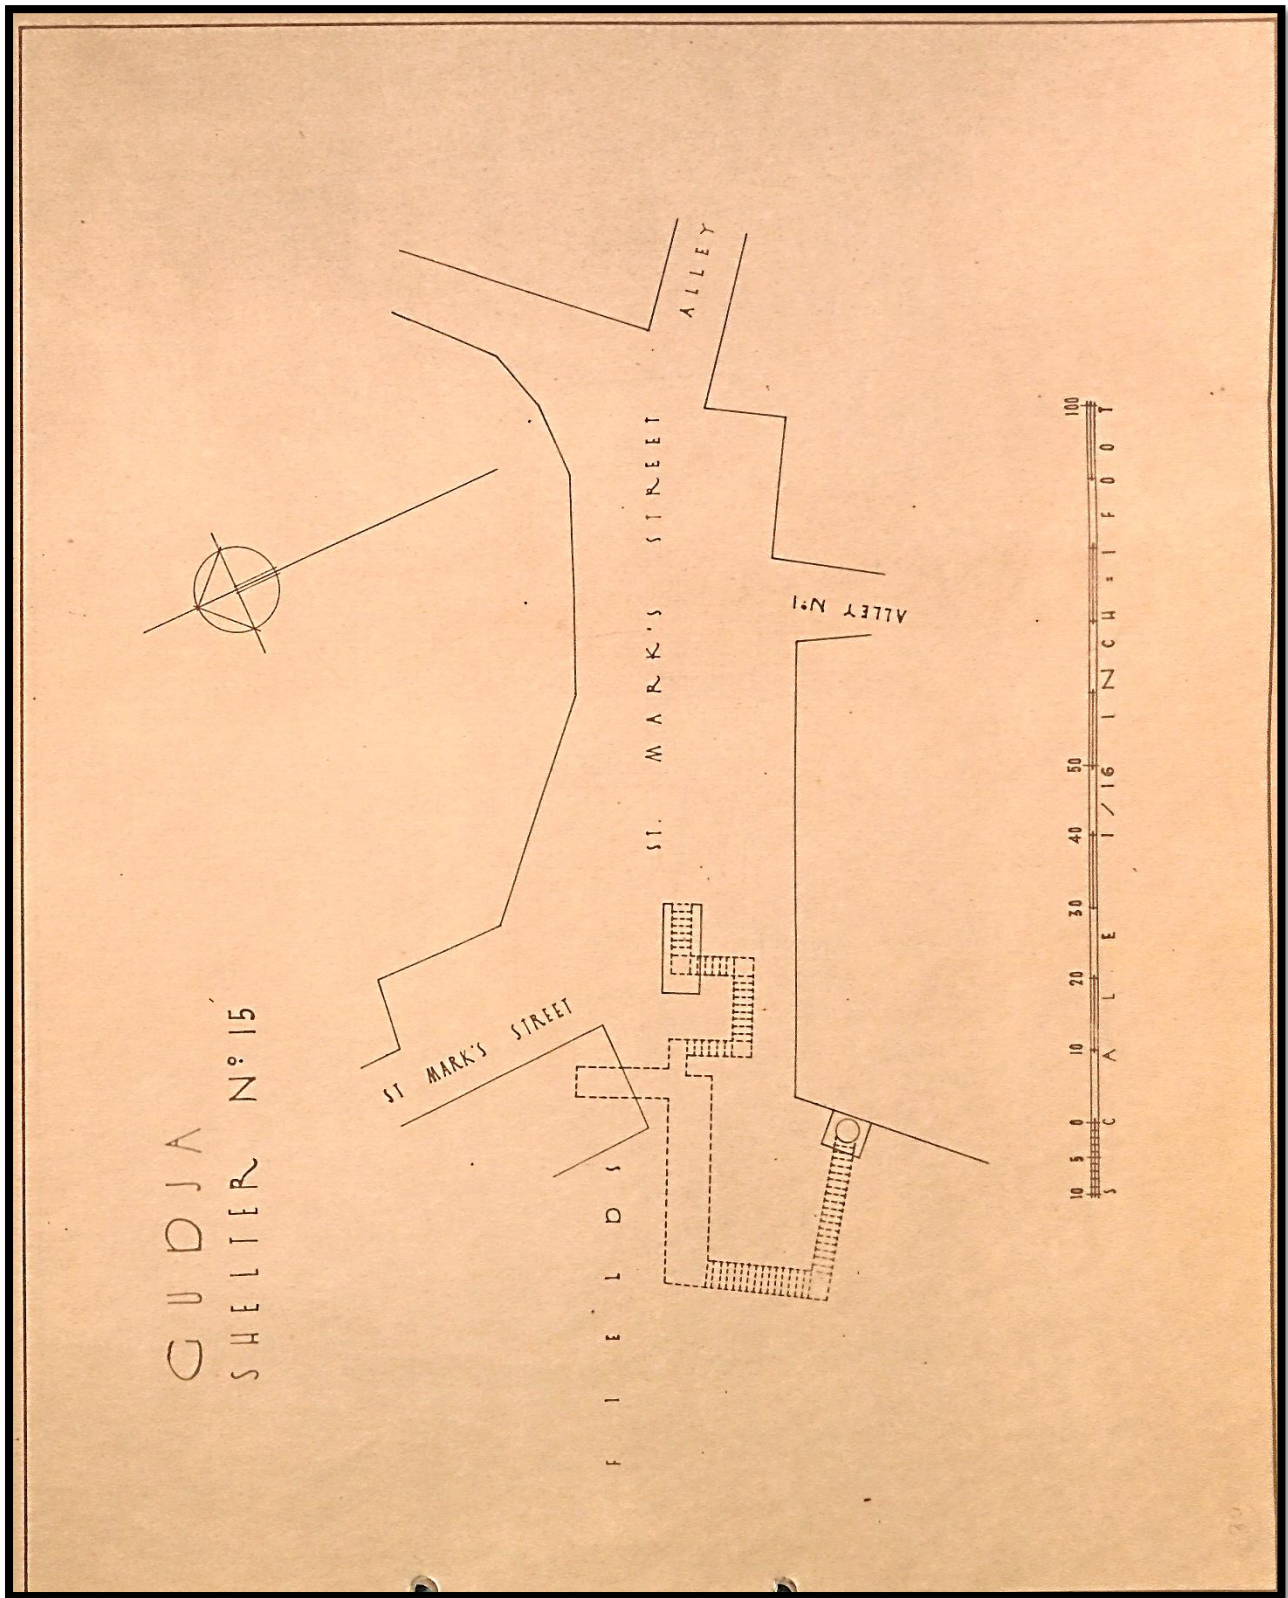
Planta do Abrigo nº15 "St. Mark's Street. – Alley nº1"
